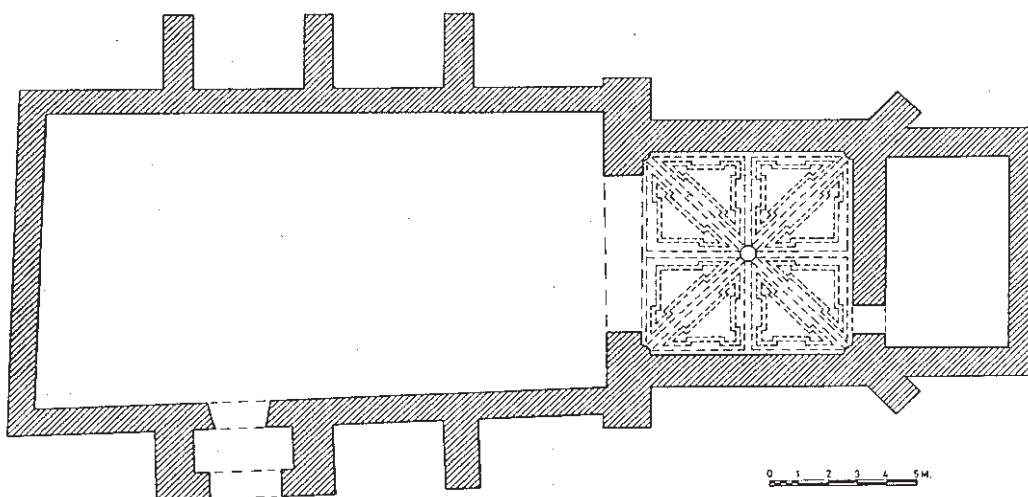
planta de la ermita de Cigales (fuente: ZALAMA RODRÍGUEZ, M. A., Ermitas y santuarios..., p. 72.)
